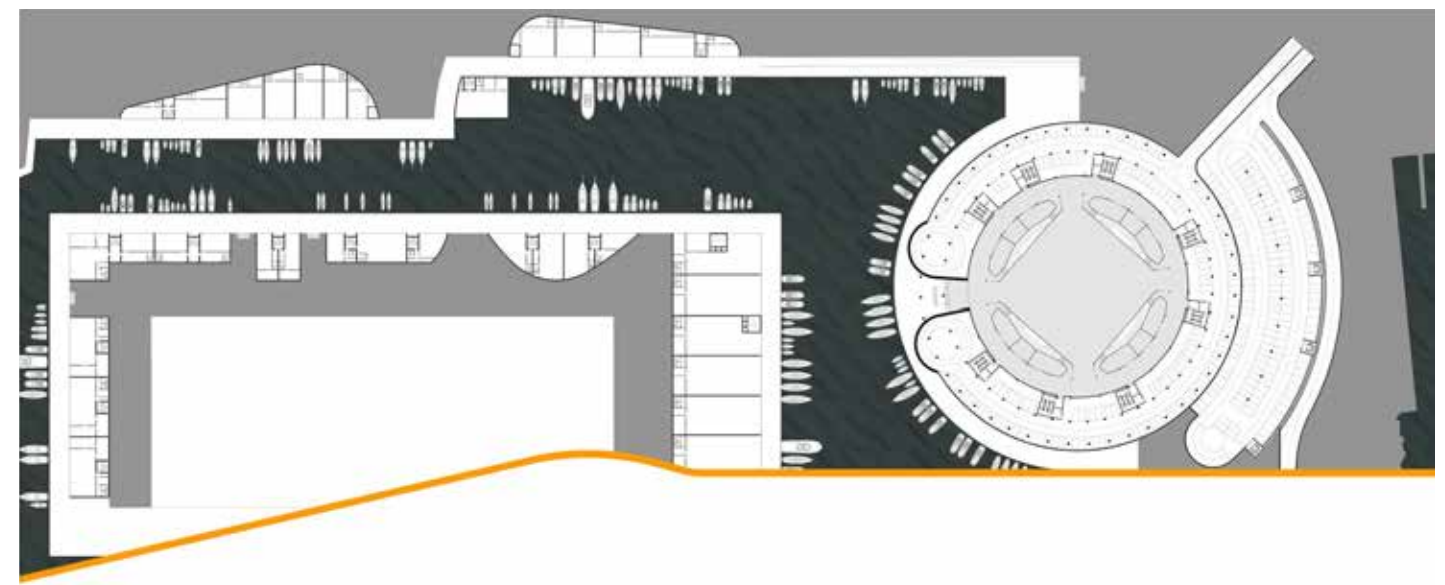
Planimetria di progetto a quota +1 metro sul livello del mare
